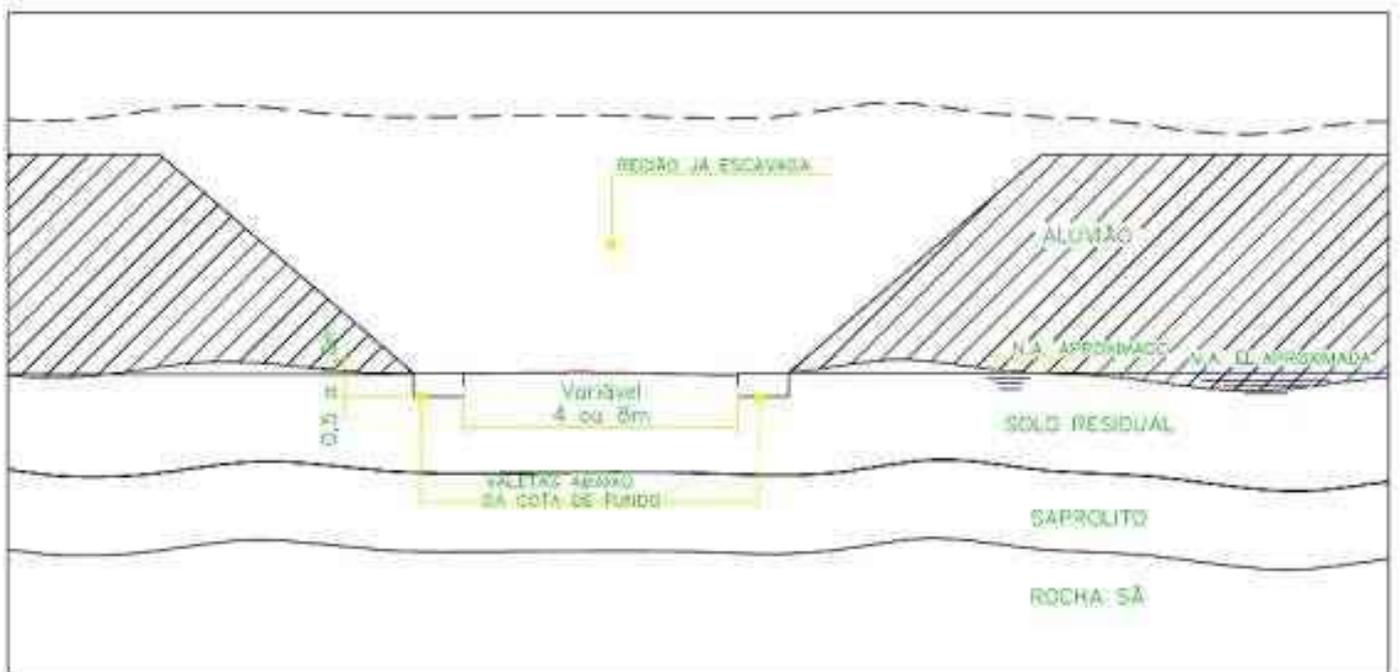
Sequência de escavação para rebaixamento do nível d'água: escavação completa
